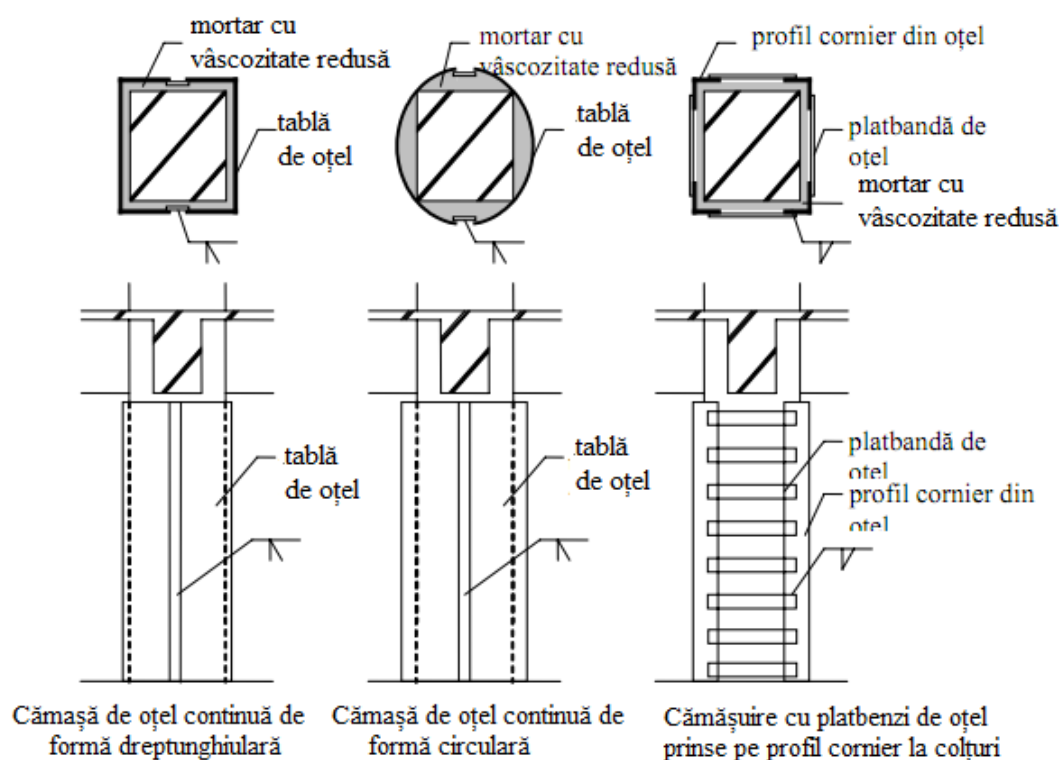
Cămășuirea stâlpilor cu piese de oțel
